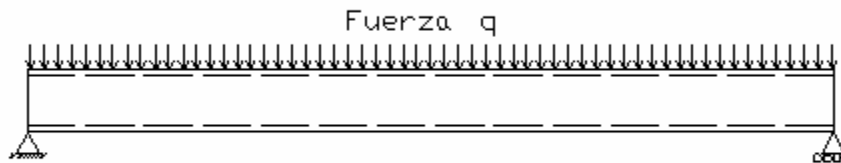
Viga hueca simplemente apoyada con carga uniformemente distribuida.
